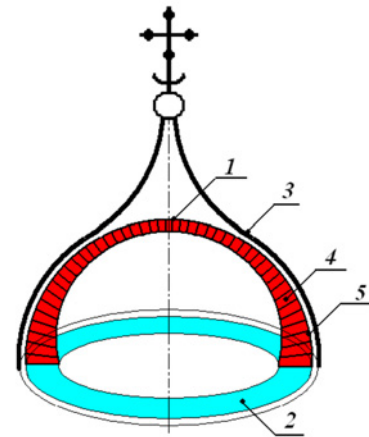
Схема кирпичного купола: 1 – вершина; 2 – основание; 3 – наружная кровля; 4 – слой кирпича; 5 – стенка
